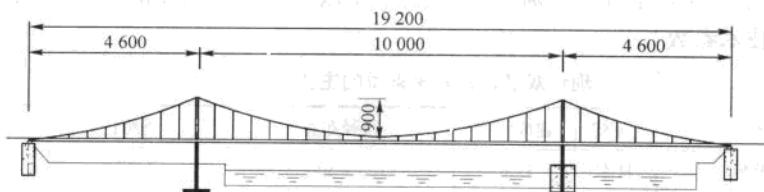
比利时安特卫普莫伯克(Merelbeke)桥桥型布置图(尺寸单位:cm)
